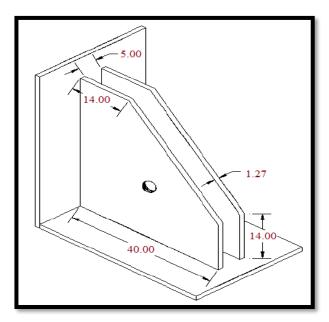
Propuesta del detalle en cm de las cartelas metálicas. Fuente: Propia
